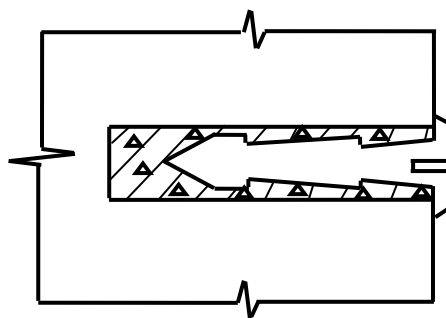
Закладка марок в фундаменты или стены зданий и сооружений
